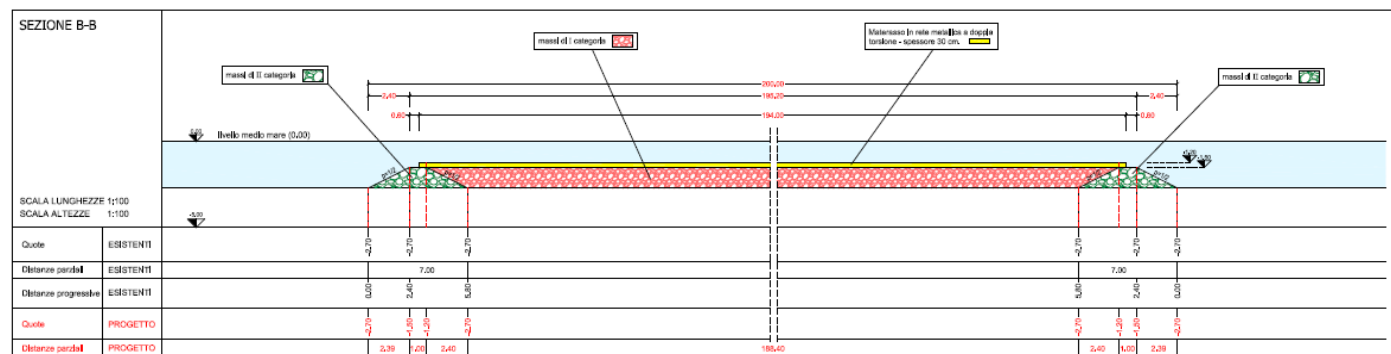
ALTERNATIVA 1 - Sezione di progetto longitudinale.
